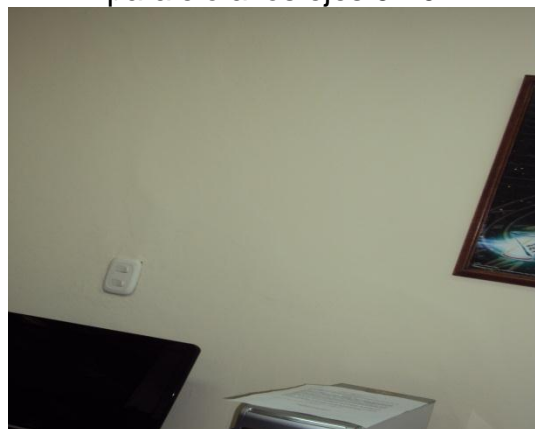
Foto N° 5 muro entre ejes 7-8 al otro extremo de Fig. 15.
